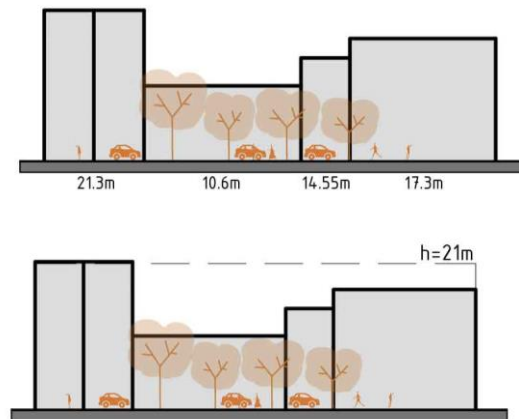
Vistas 4 do terreno analisado para as fachadas da Rua Carlos Sampaio.
